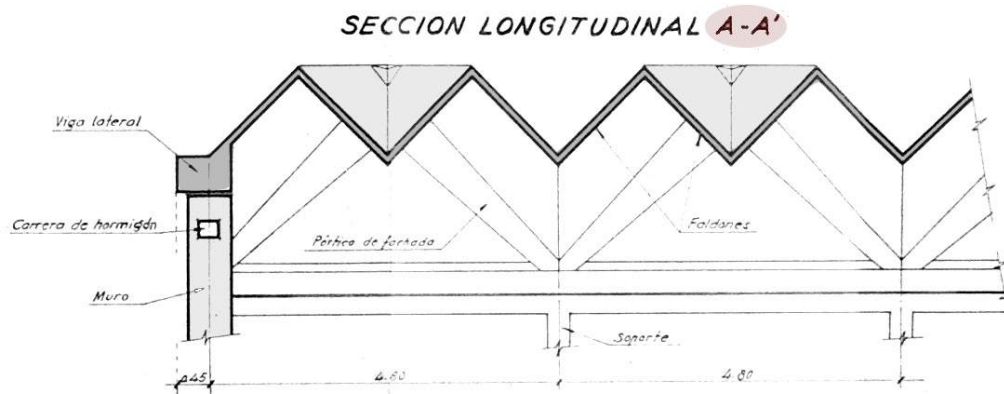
SECCIÓN LONGITUDINAL A - A'
